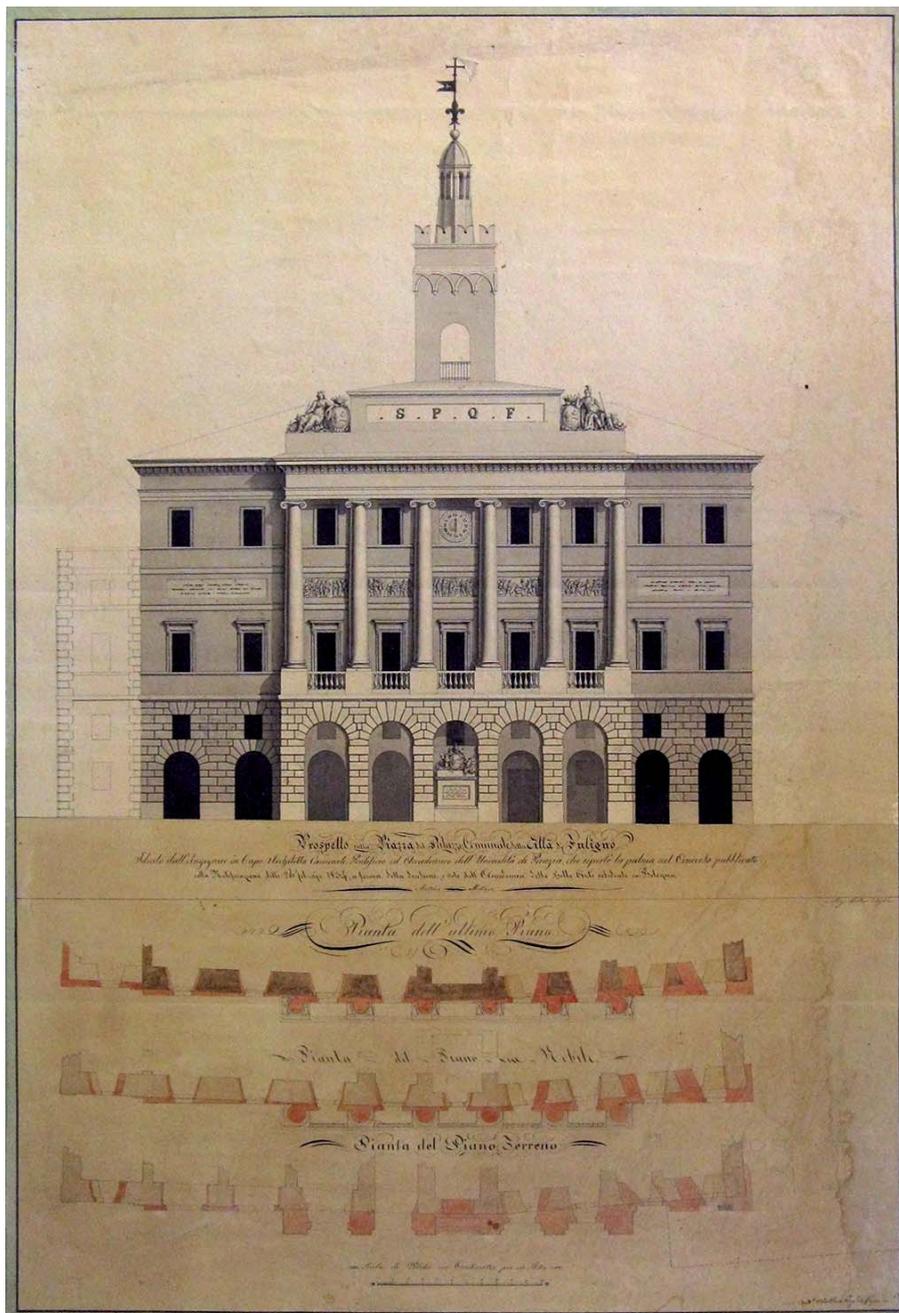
Antonio Mollari, *Prospetto sulla piazza del Palazzo Comunale della Città di Foligno ideato dall'Ingegnere in Capo Architetto Camerale Pontificio ed Accademico dell'Università di Perugia, che riportò la palma del Concorso pubblicato colla Notificazione delli 26 febbrajo 1834, a forma della decisione, e voto dell'Accademia delle Belle Arti residente in Bologna, 1834, BCF, X, 15/3.
